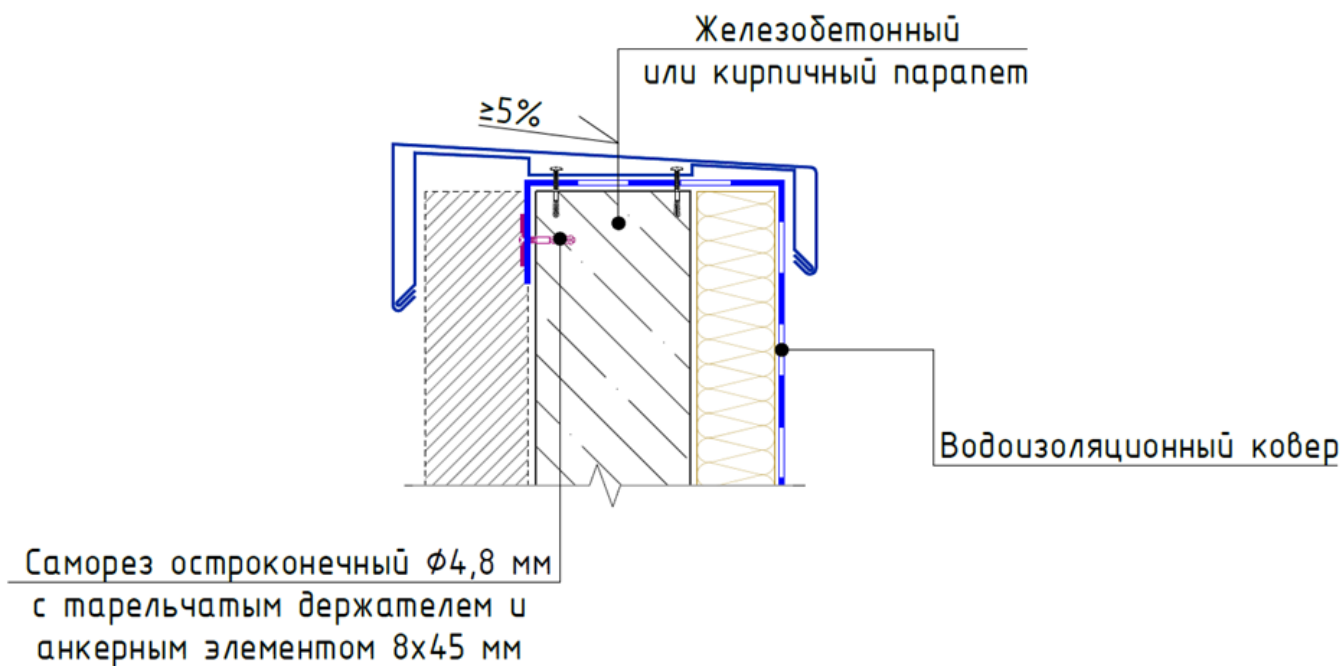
Крепление свободного конца водоизоляционного ковра к железобетонному или кирпичному парапету
